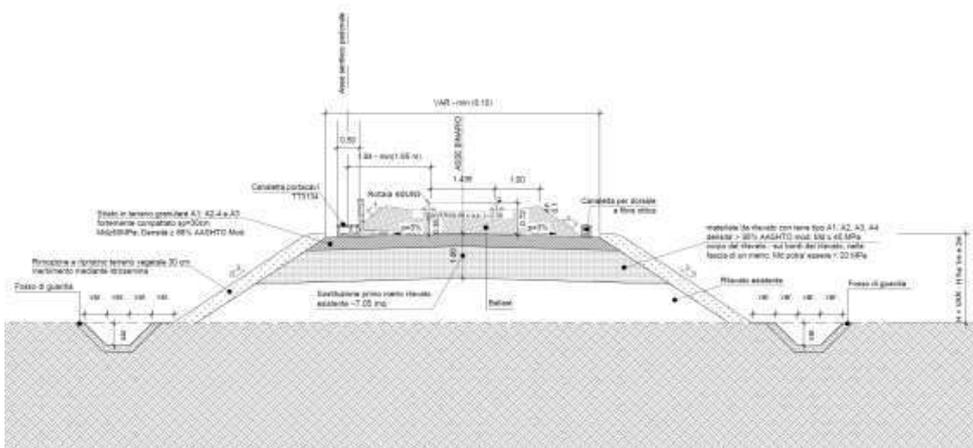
Sezione tipo 1 per rilevati di altezza inferiore a 2.00m
